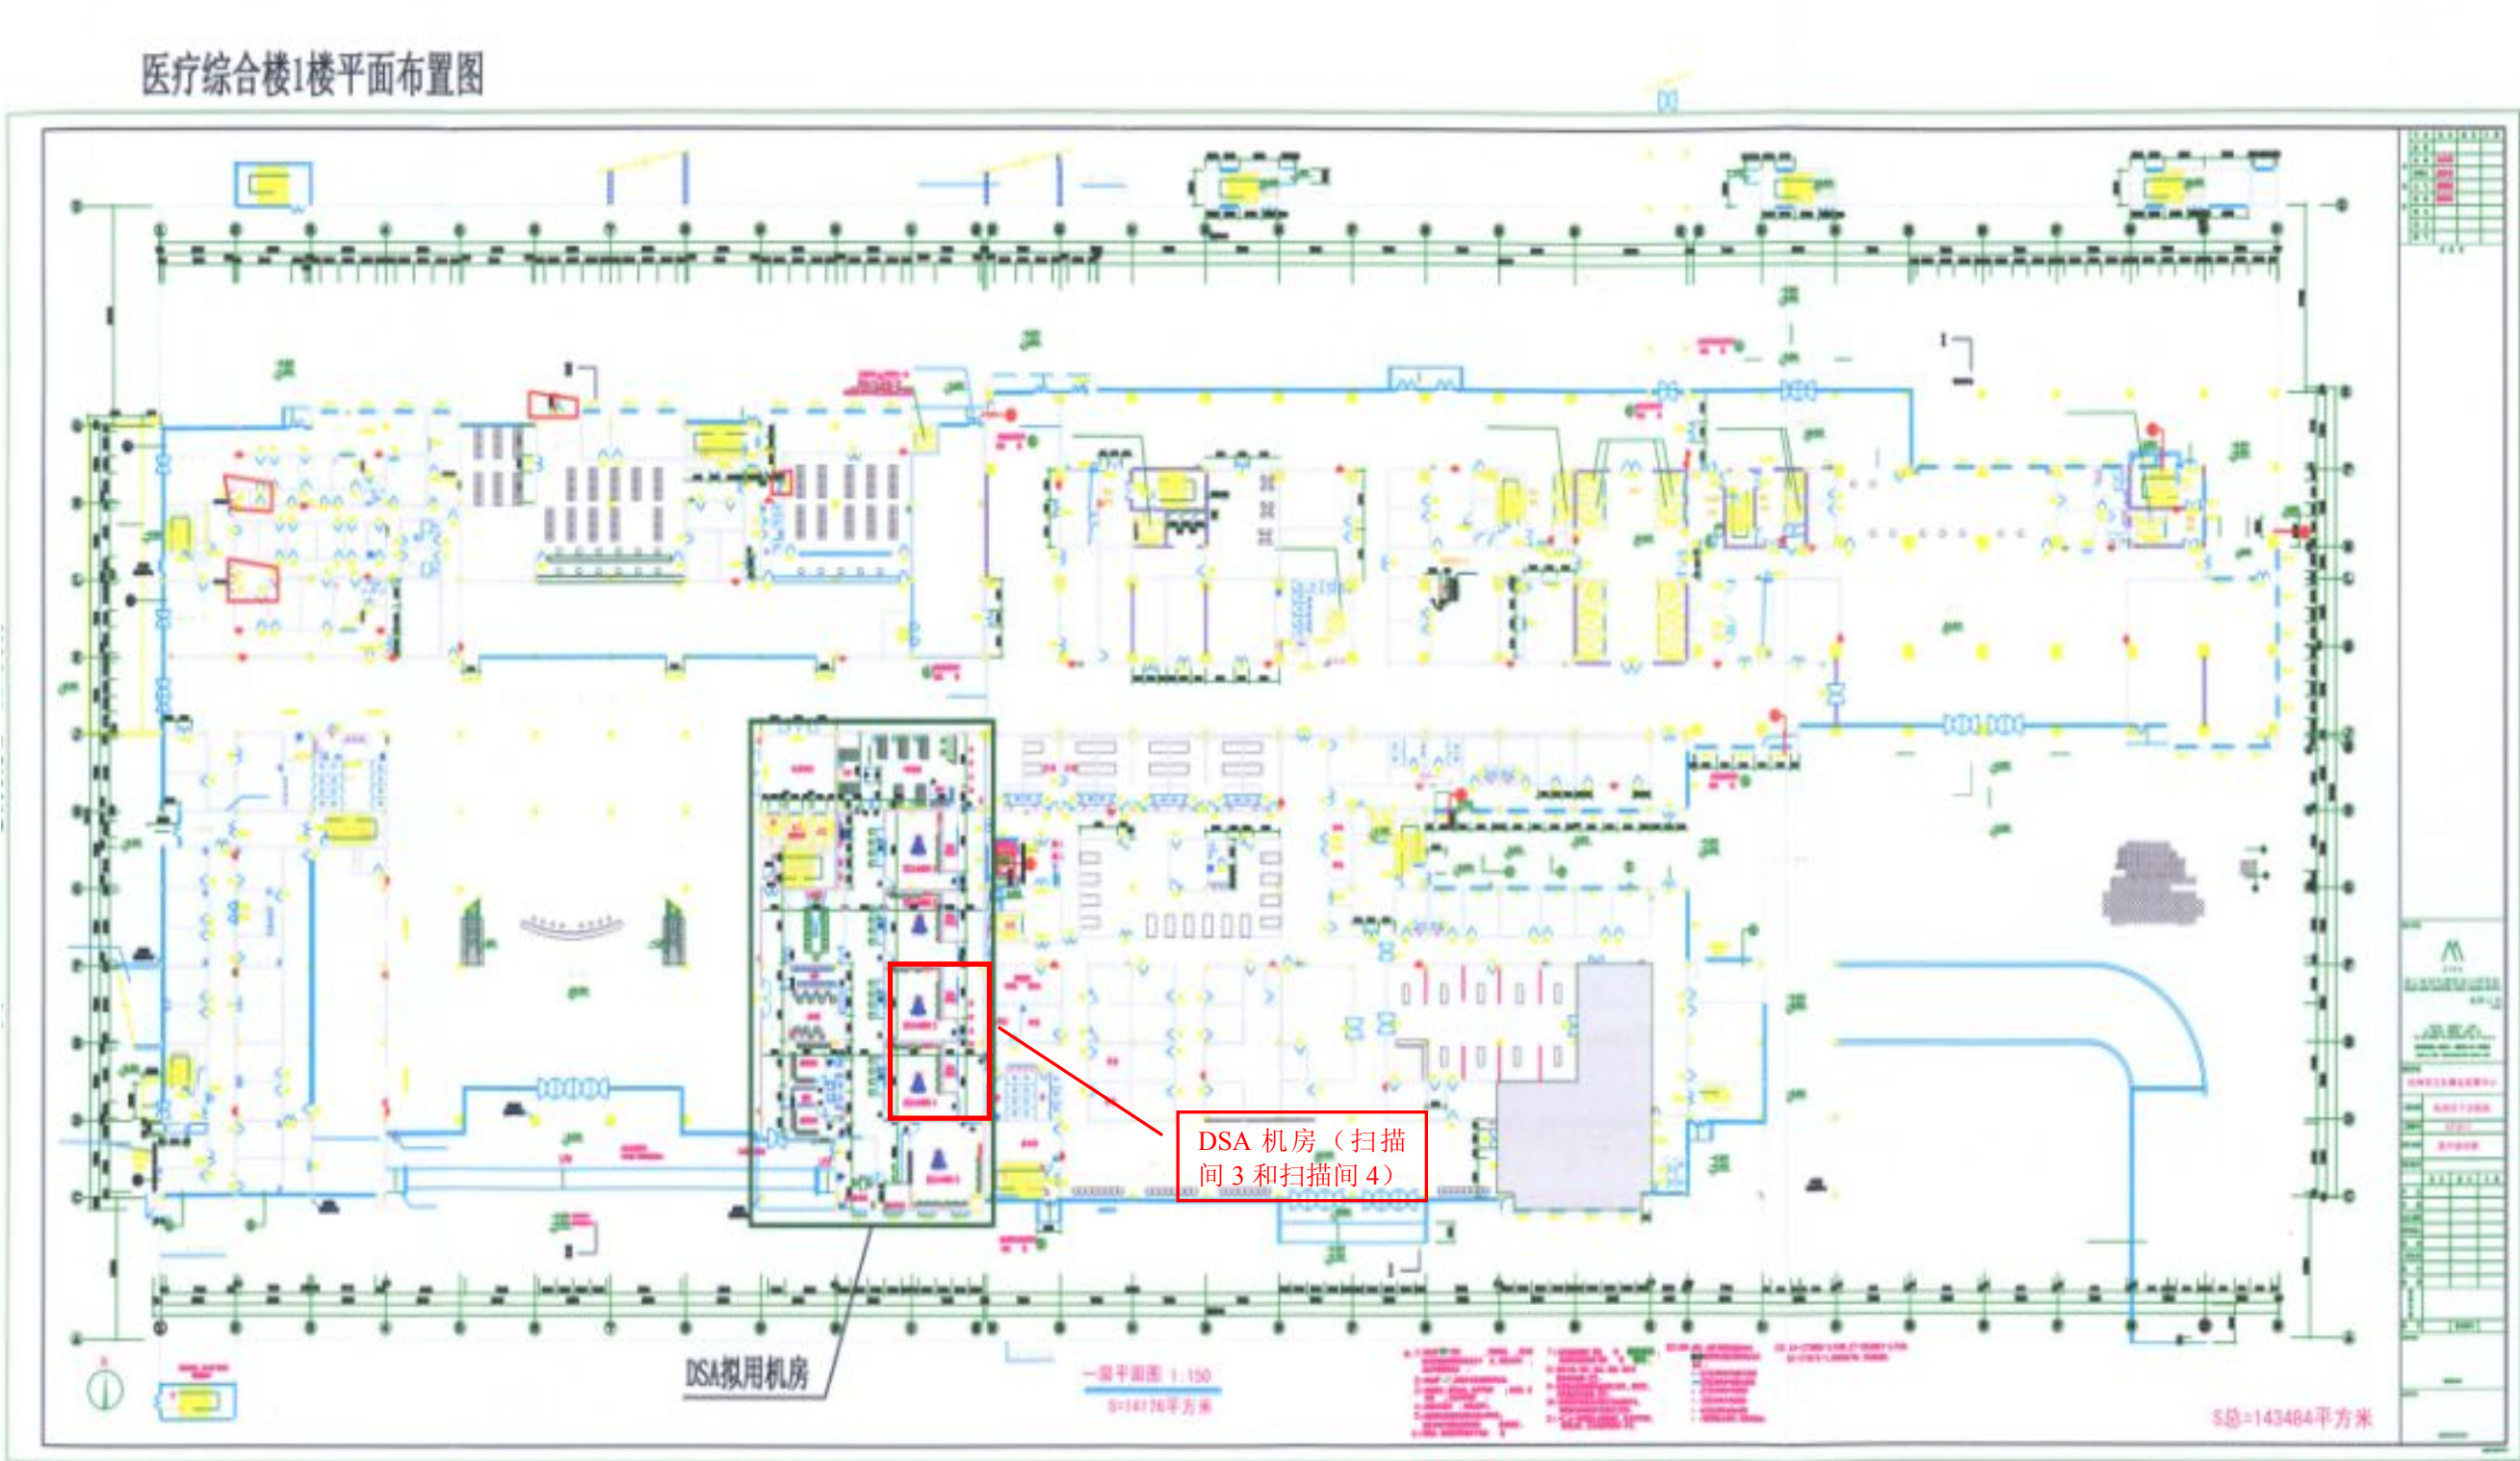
本次验收 DSA 机房（扫描间 3 和扫描间 4）平面布置图
